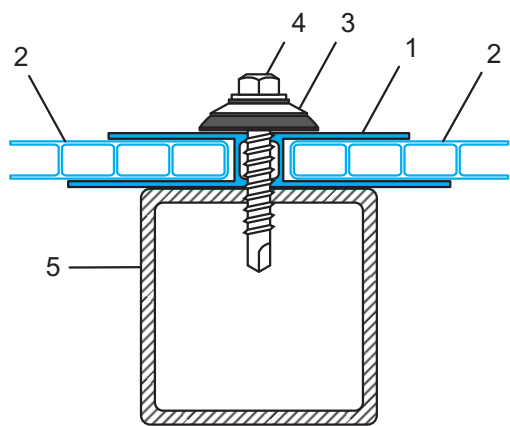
HP - неразъёмный соединительный поликарбонатный профиль.
